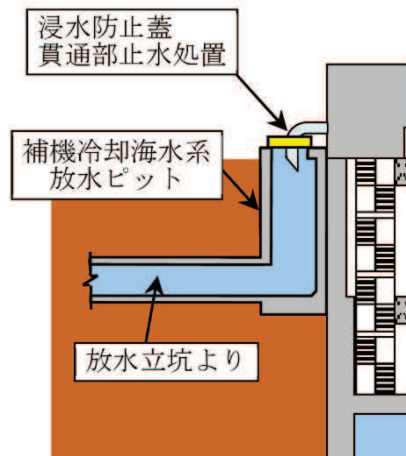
3号機 放水立坑 浸水対策配置図 (A-A 断面図)
